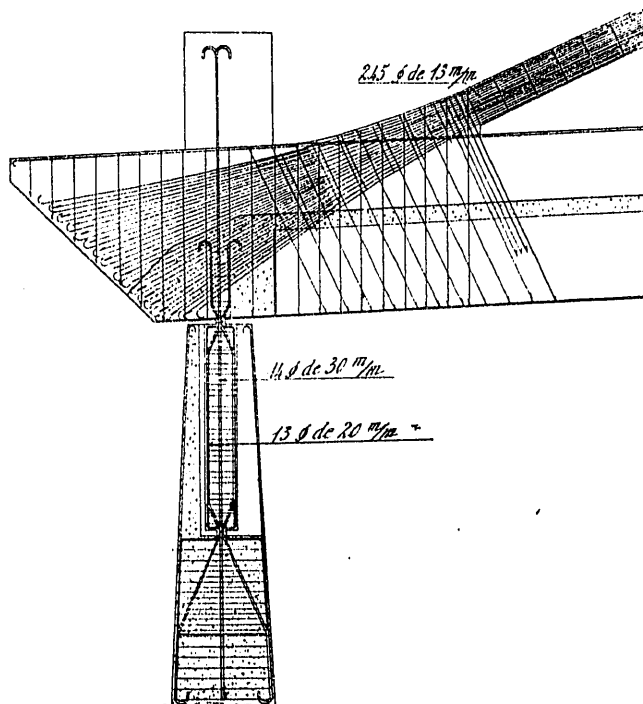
ª Anclaje del arco y articulación en la pila contrapeso
